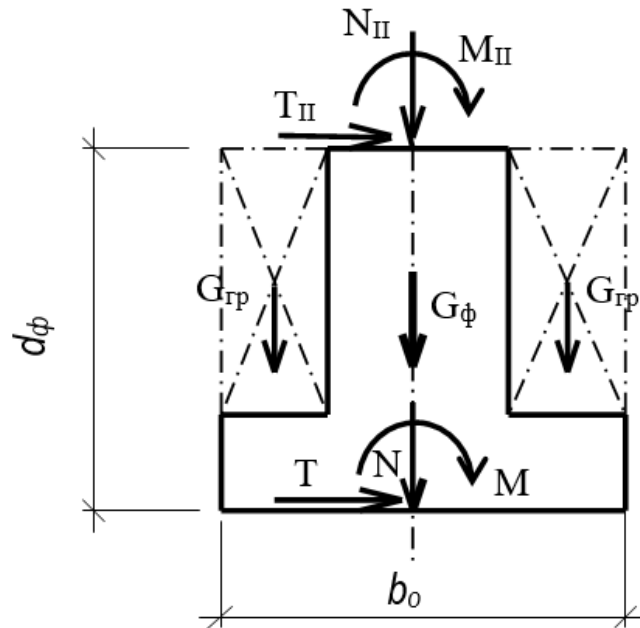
Кінцева розрахункова схема фундаменту на природній основі
